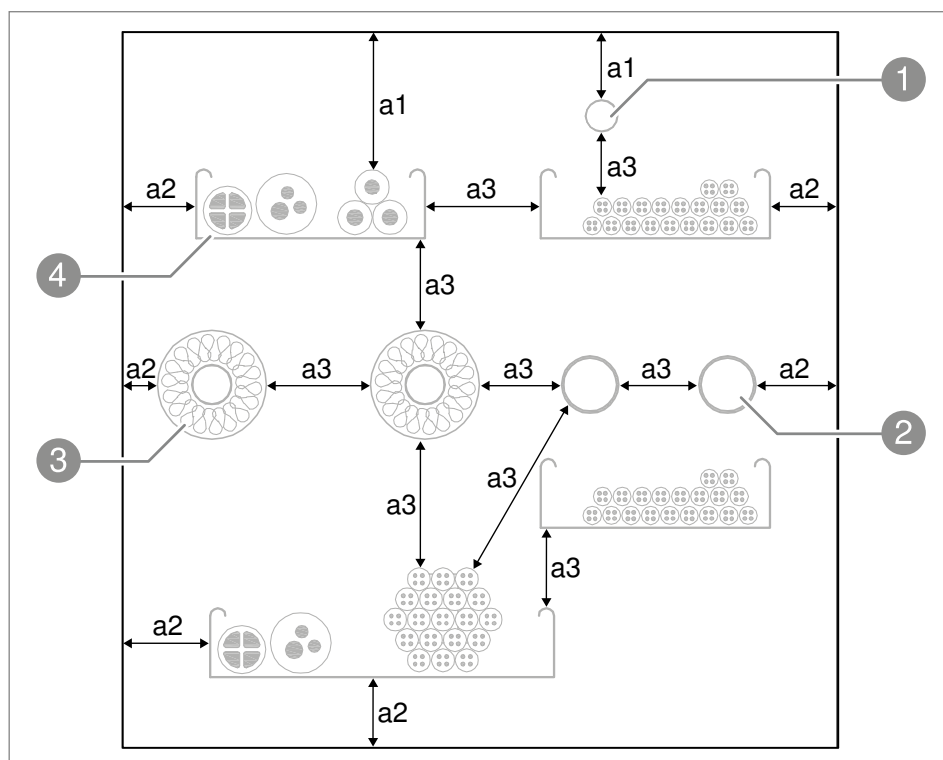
Distanze minime dall'intradosso dell'elemento costruttivo e tra le installazioni
